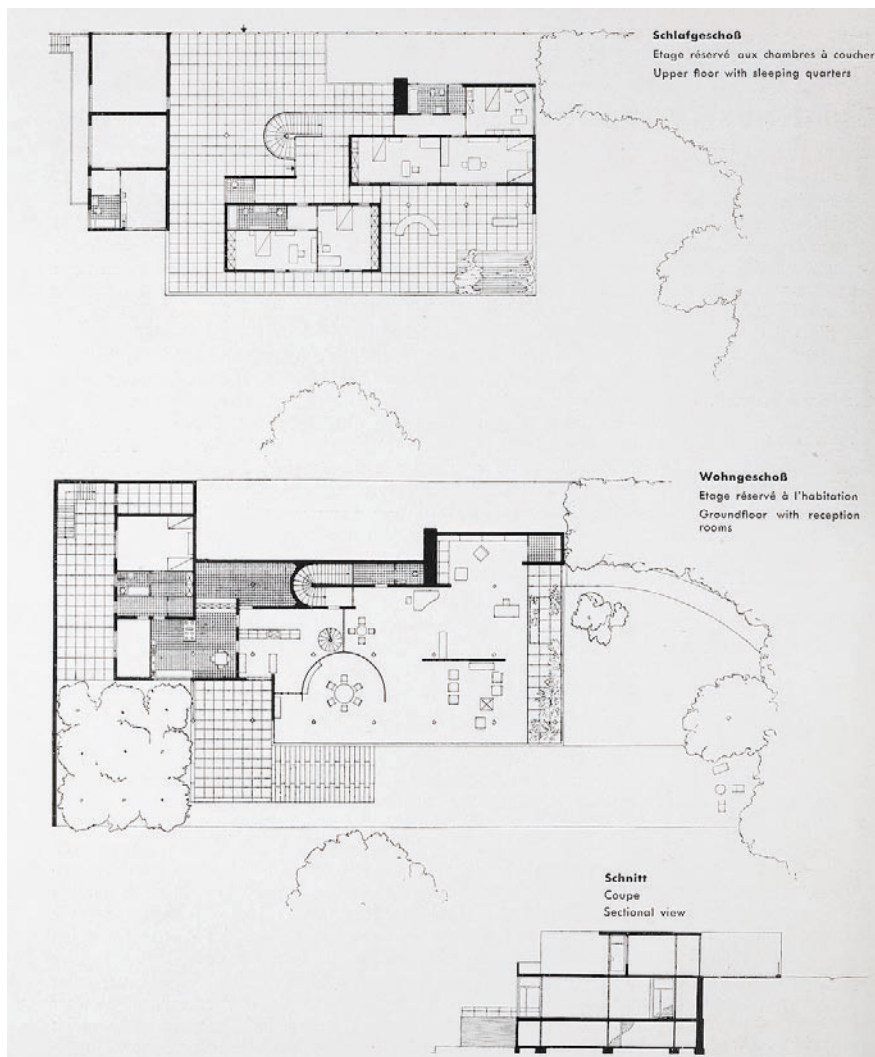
Haus Tugendhat, Grundriss, 1931.
